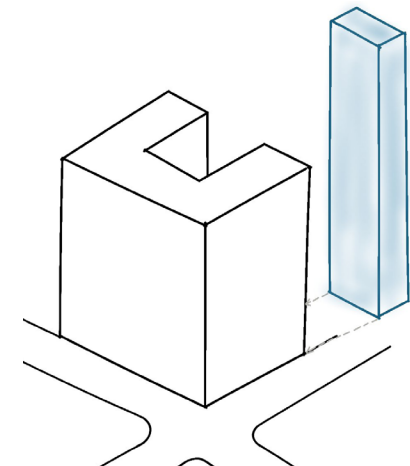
Estrategia de la construcción del edificio auxiliar. (Autoría propia, 2021).
